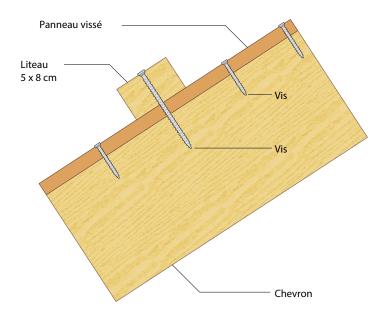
Exemple de fixation de liteau sur le chevron au travers de la plaque
